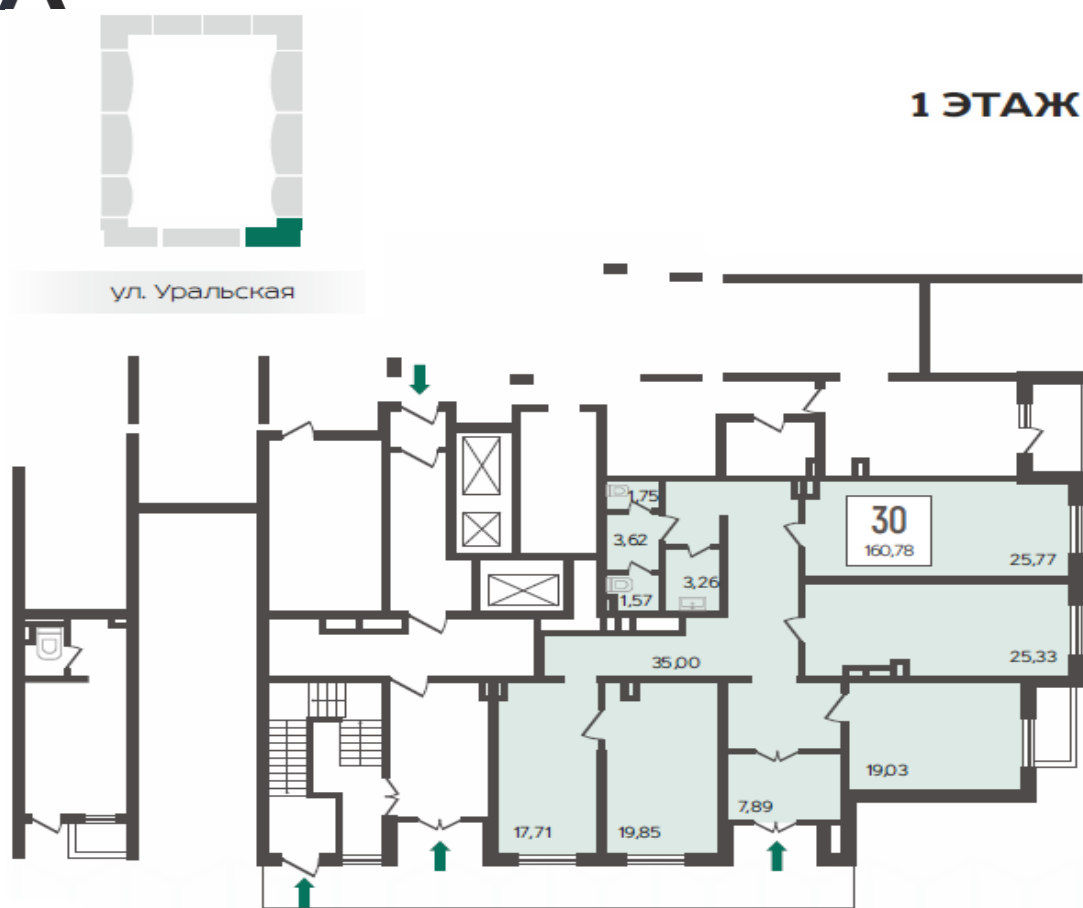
План коммерческих помещений 1 этажа БС-12 ЖК URAL
